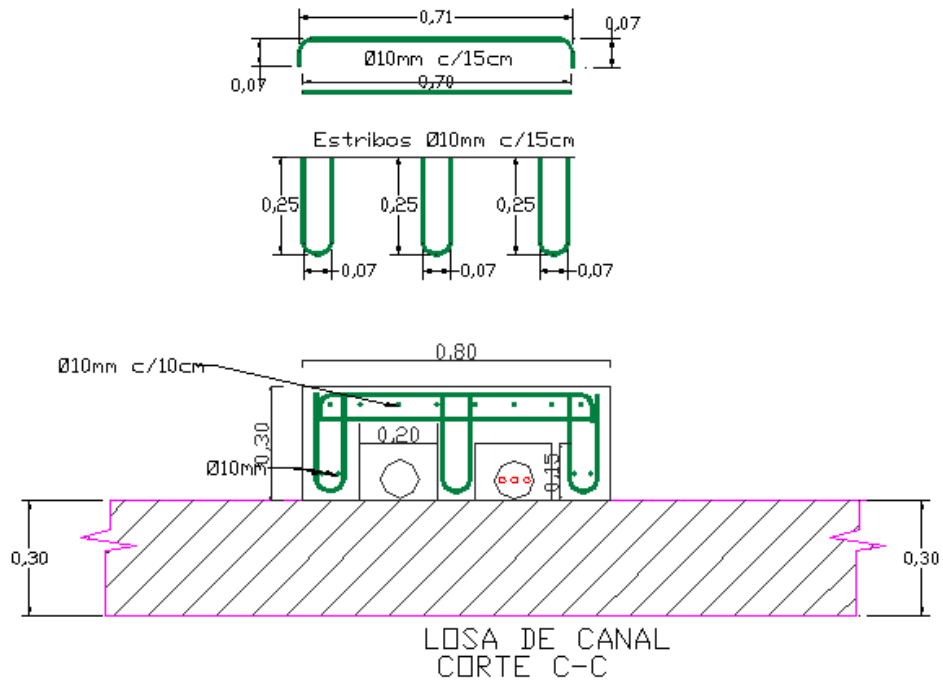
c: Detalle viga alojamiento. Armadura. Edet Av. Guzman.
